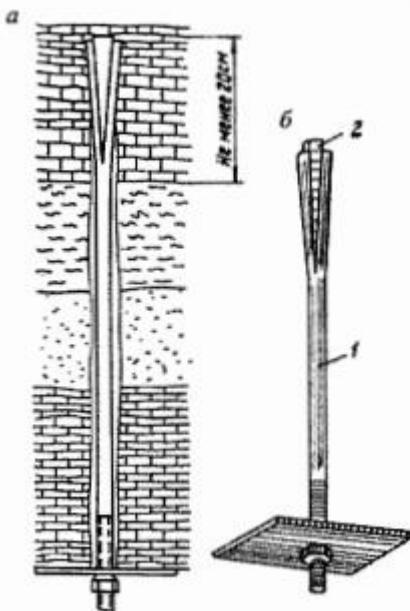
Схема анкерного крепления (а) и клинощелевой штанги (б)
